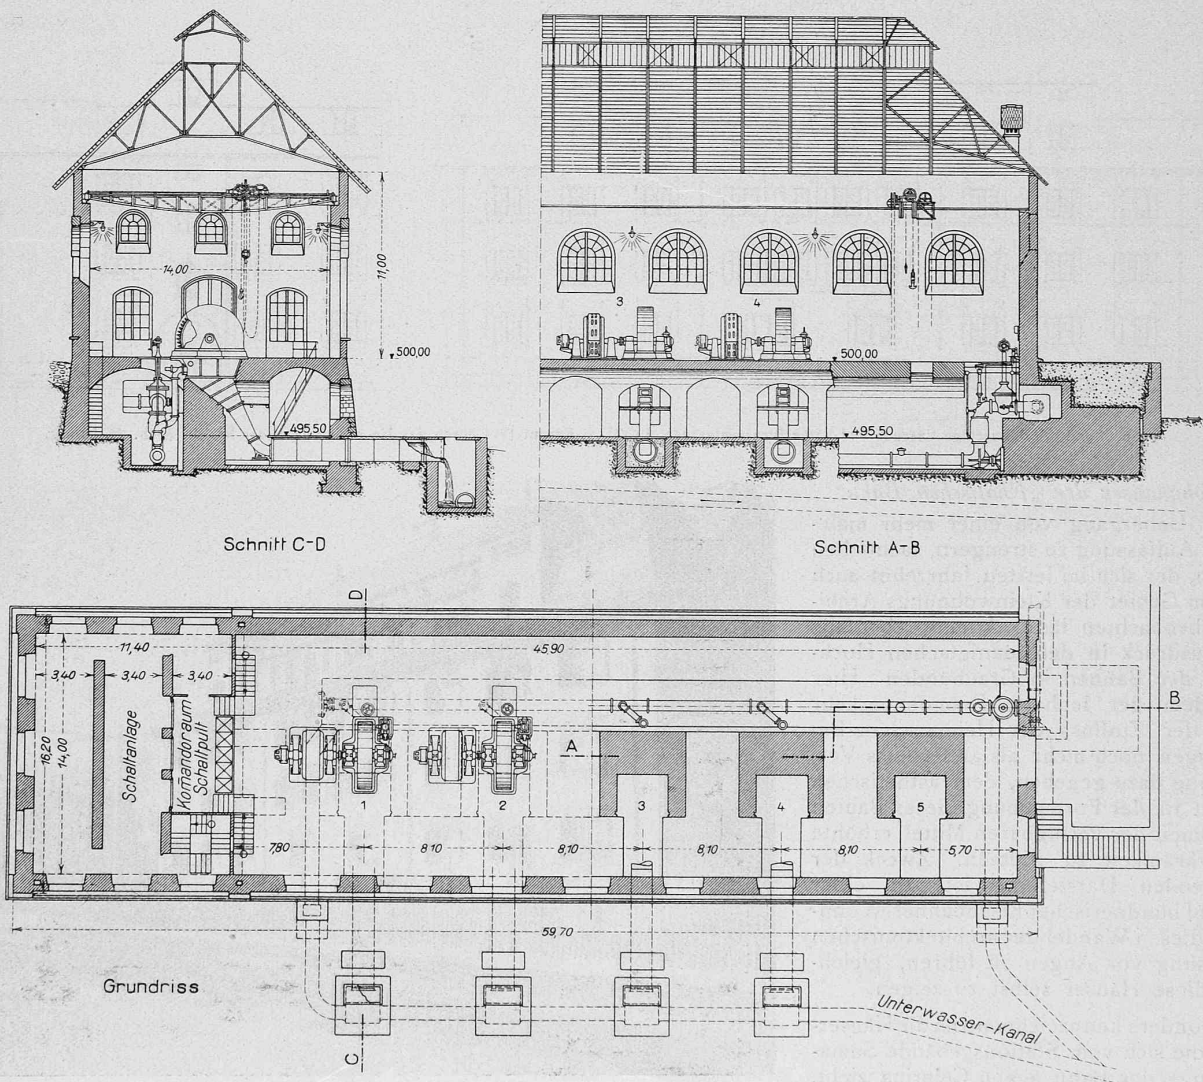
Grundriss und Schnitte des Maschinen- und Schalthauses der Wasserkraftanlage Fully. — Masstab 1:400.
